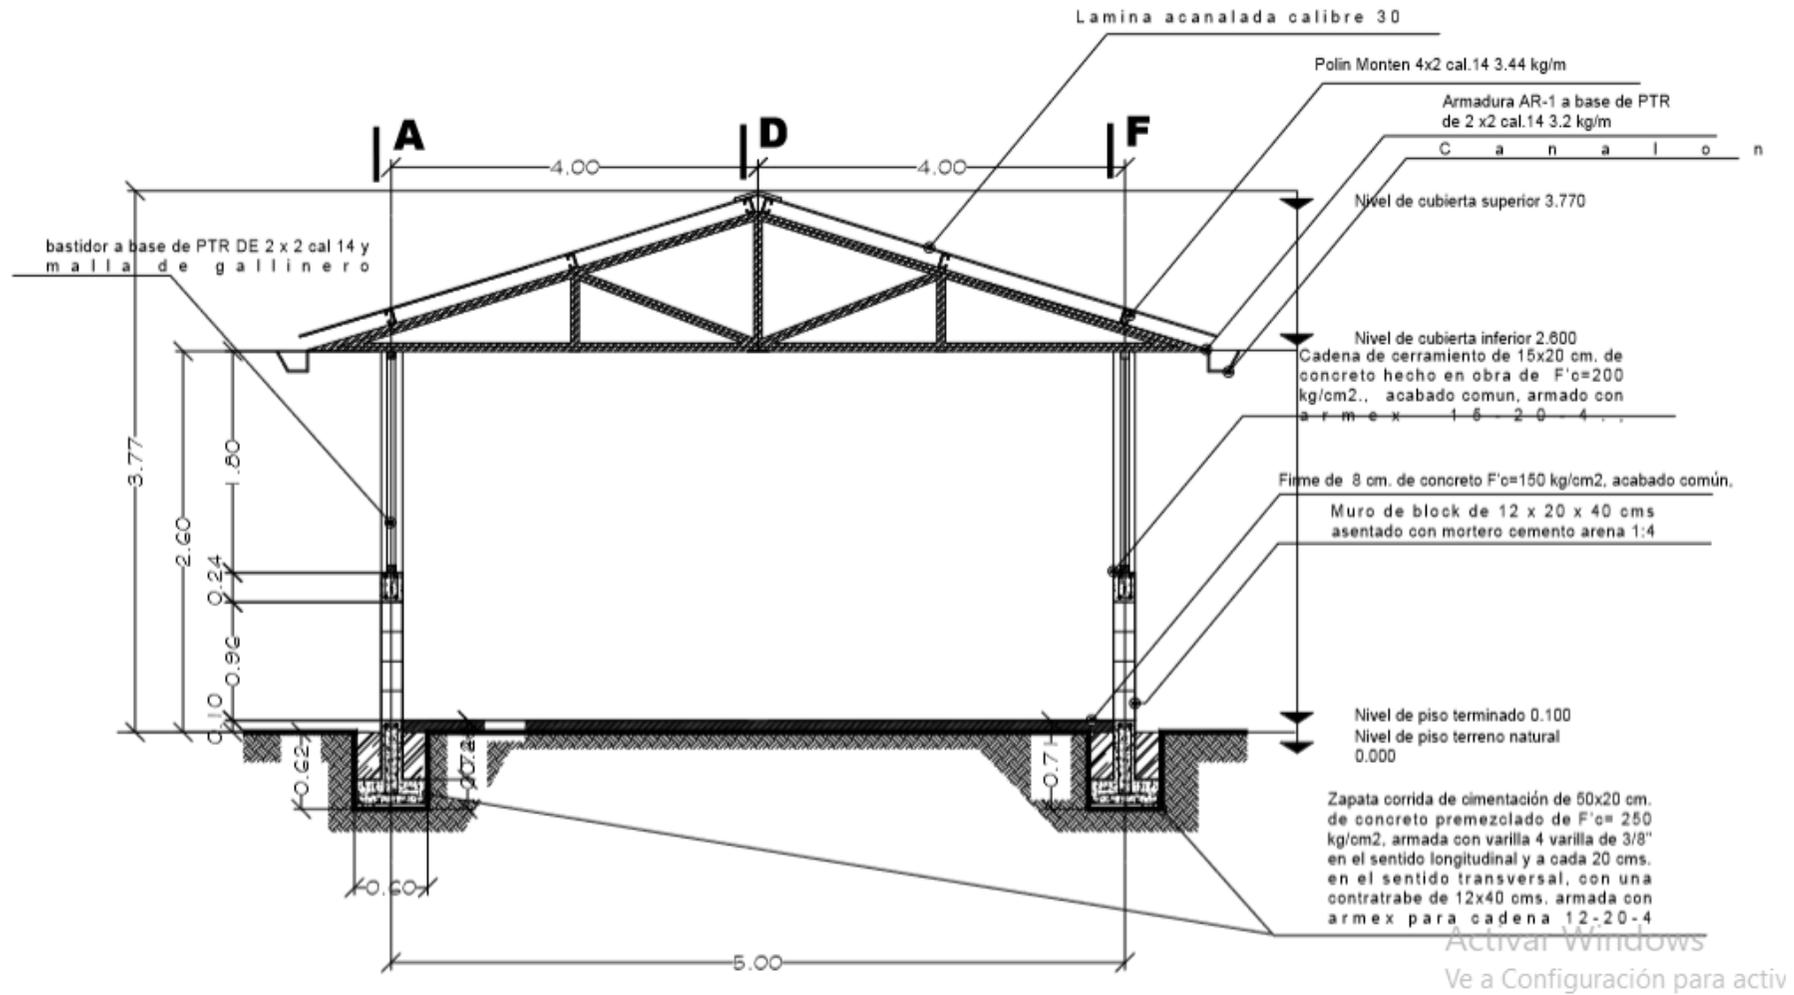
Murillo. (2017) Detalle de fachada aprisco. Bogotá: Colegio Rural José Celestino Mutis –IED.
